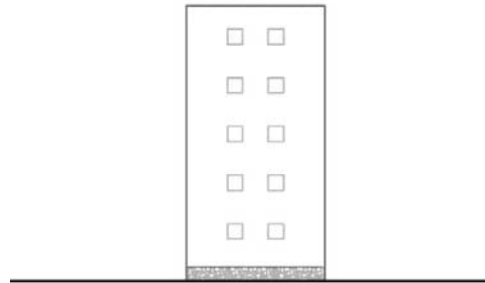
Fachada Este y Oeste [Anexo II. Planos]
